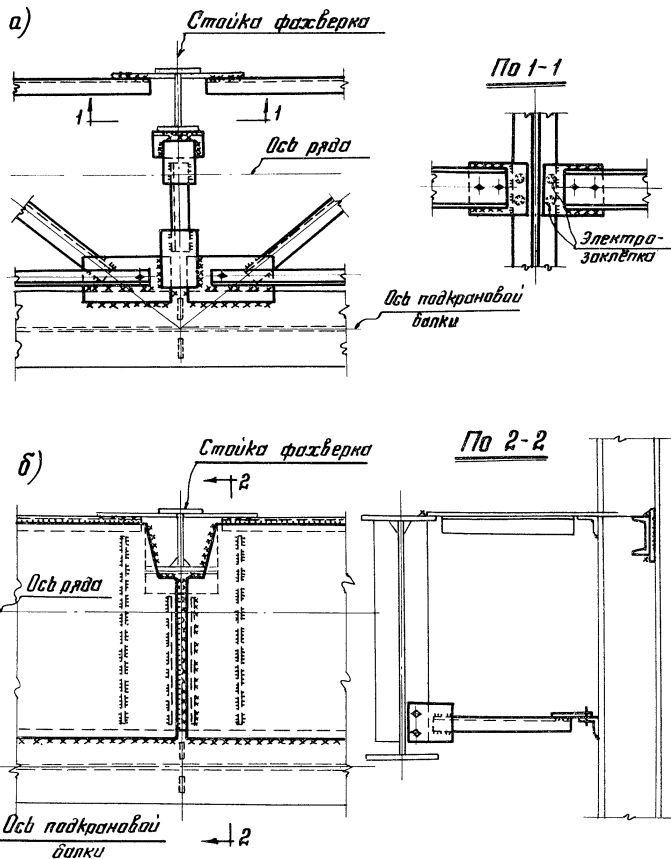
Крепление стальной стойки фазверка к тормозной конструкции:
